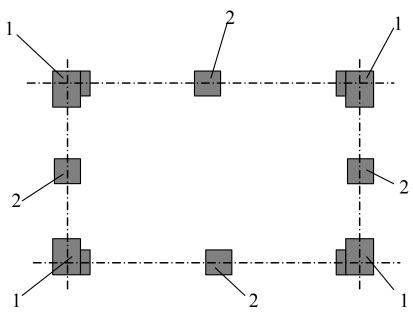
Порядок установки фундаментных блоков: 1- маячные блоки; 2- рядовые блоки
